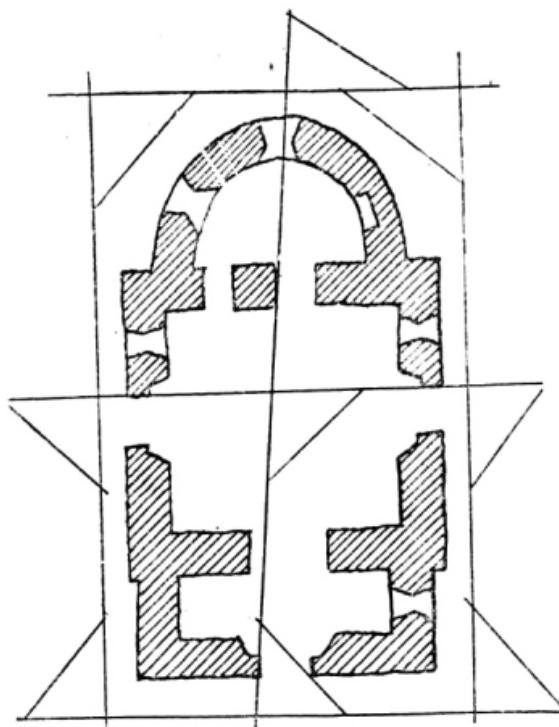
План здания со связанными между собой наружными и внутренними причалками
